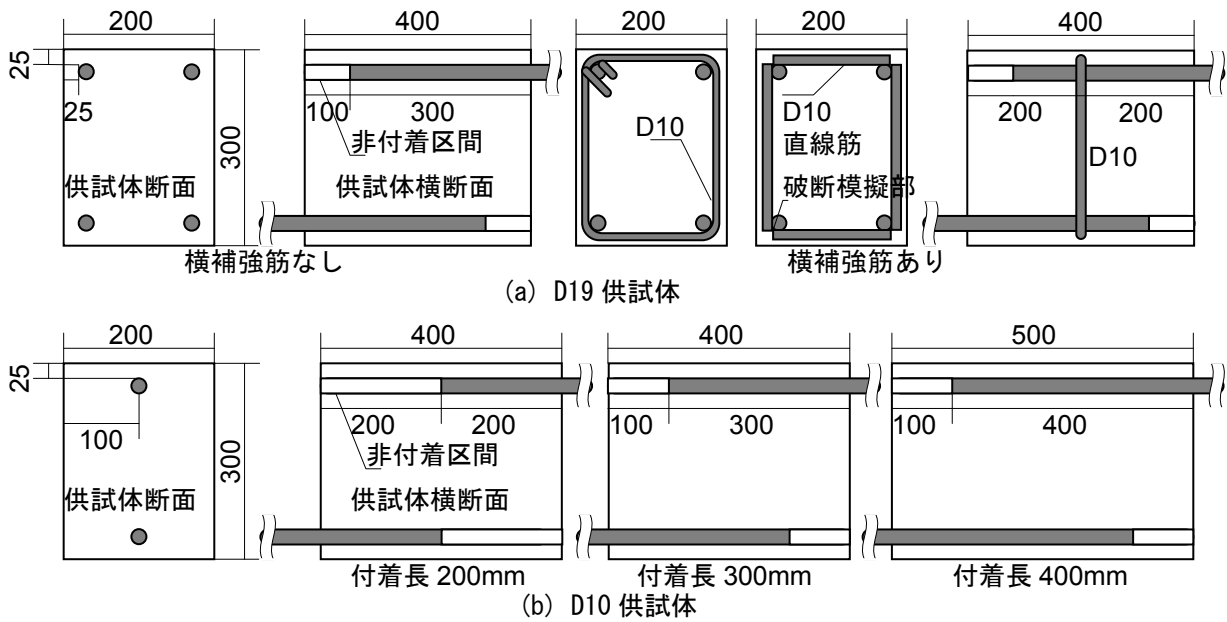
供試体形状・寸法および配筋状況 (単位: mm)
